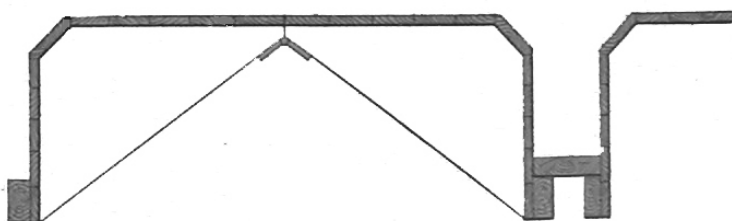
Cofragem tipo de laje nervurada em corte (in Ransome, 1912: 157).
